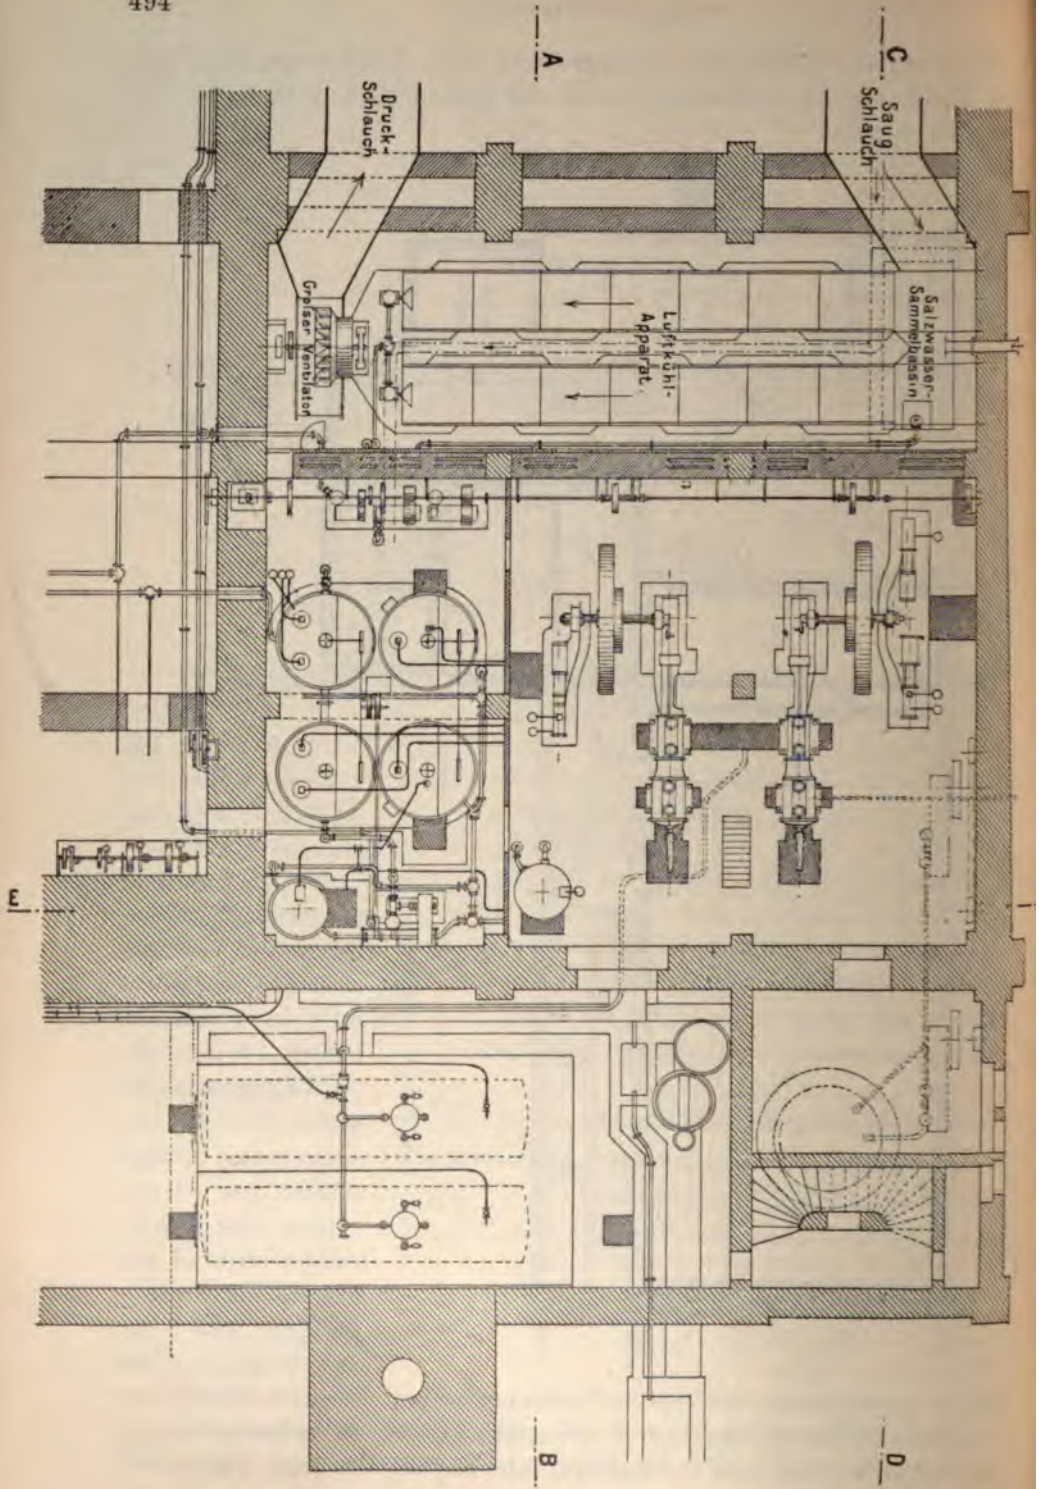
Grundriss der Maschinen- und Kühlanlagen. 1:200.
